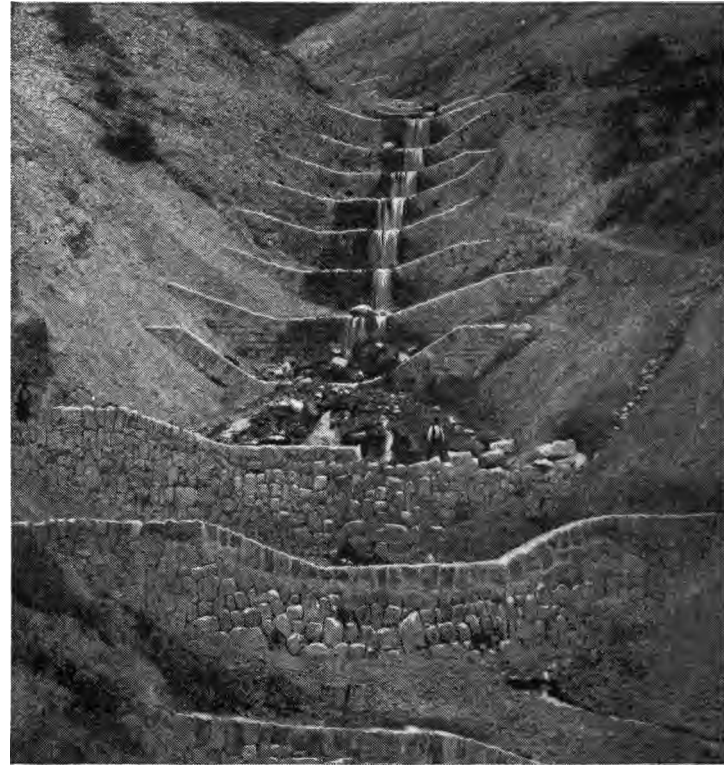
Barrages successifs sur le lit d'un torrent.
